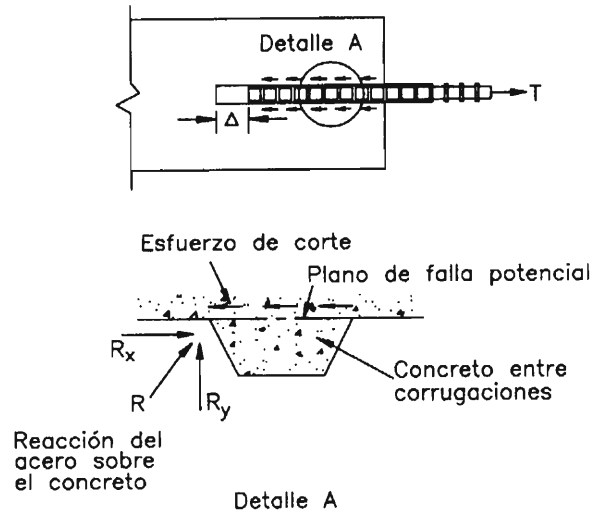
Aplastamiento del concreto entre corrugaciones de las varillas de acero
